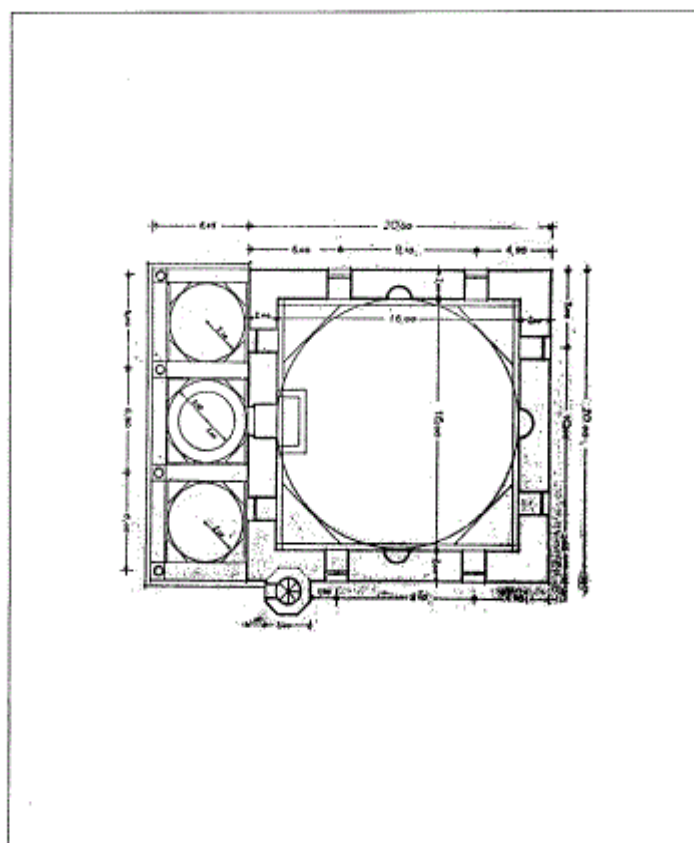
مسقط أفقي لمسجد محمد بك في سيريز (عن : كيل) .
